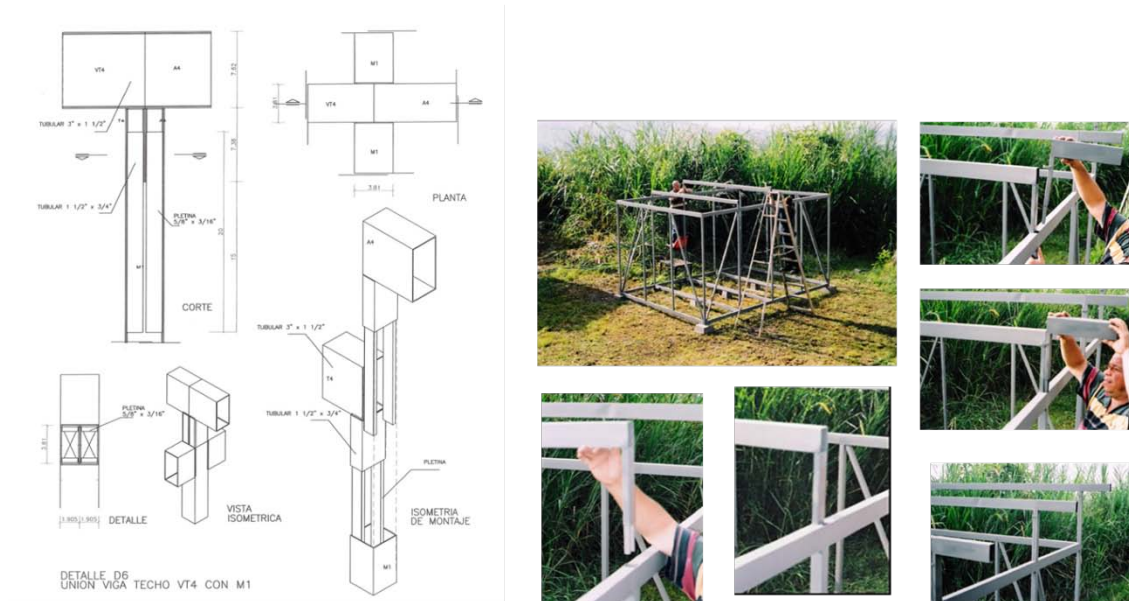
Detalle unión Viga Techo VT4 con Marco M1. F: Ana Marrero
